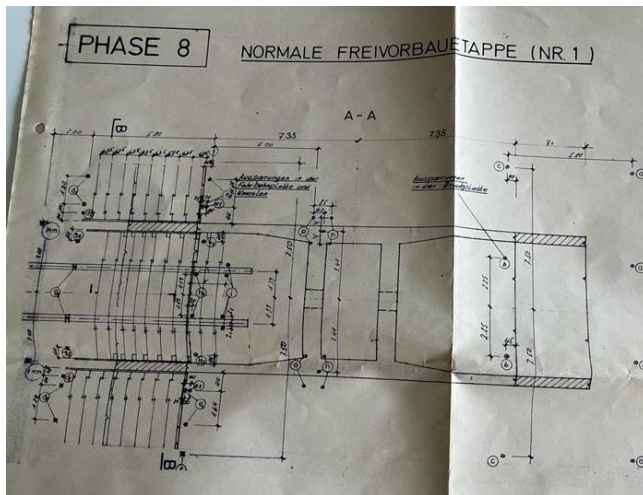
Freivorbauwagen im Grundriss
